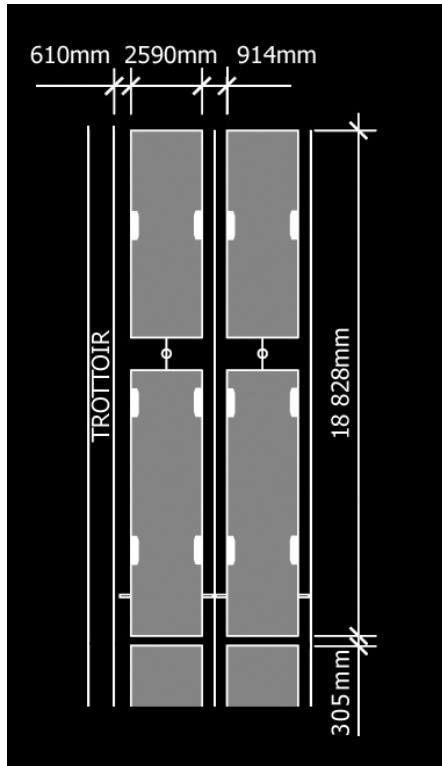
DIMENSIONS HORS-TOUT ET ESPACEMENTS
